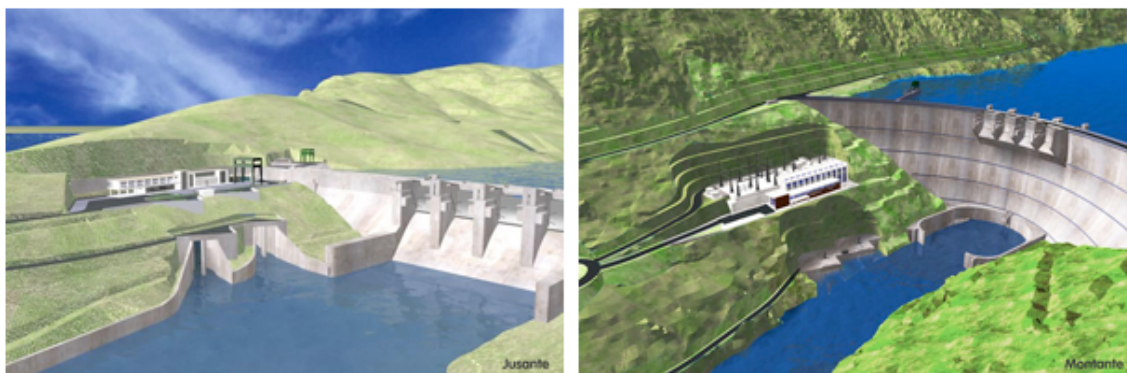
Barragens do Baixo Sabor (EDP, 2010).
